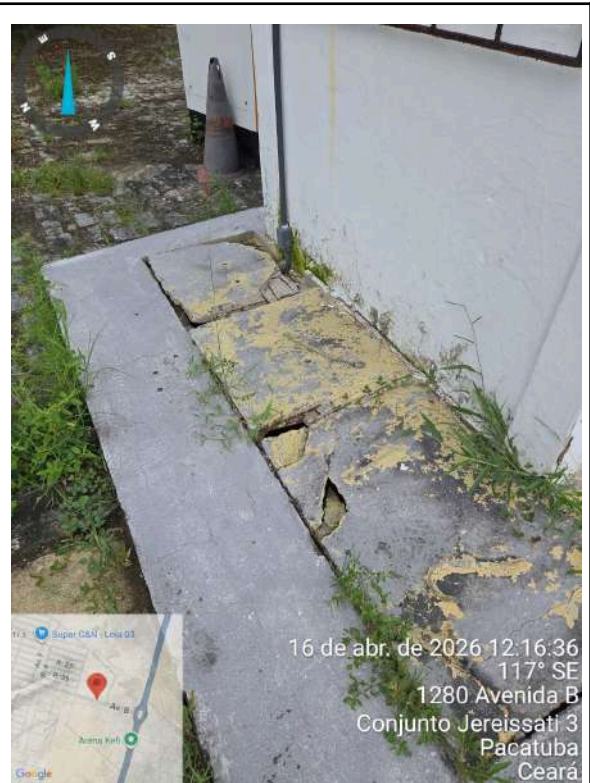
EEE-03: tampas de esgoto com rachaduras e armadura aparente.
